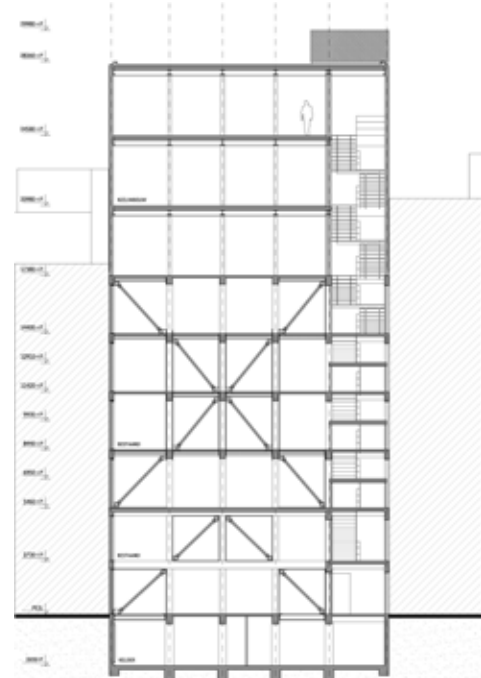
Detail Fassade u. Schnitt © Luechinger Architects
